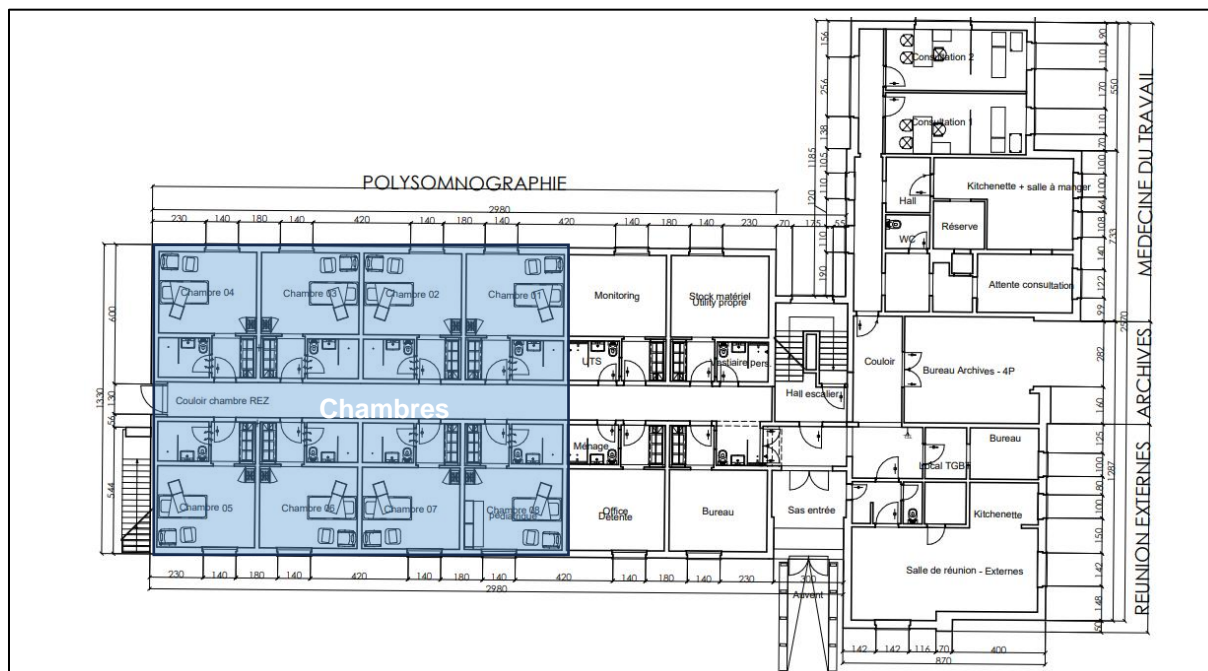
Proposition pour le rez-de-chaussée de la Clinique du Sommeil (source : assar architects)
